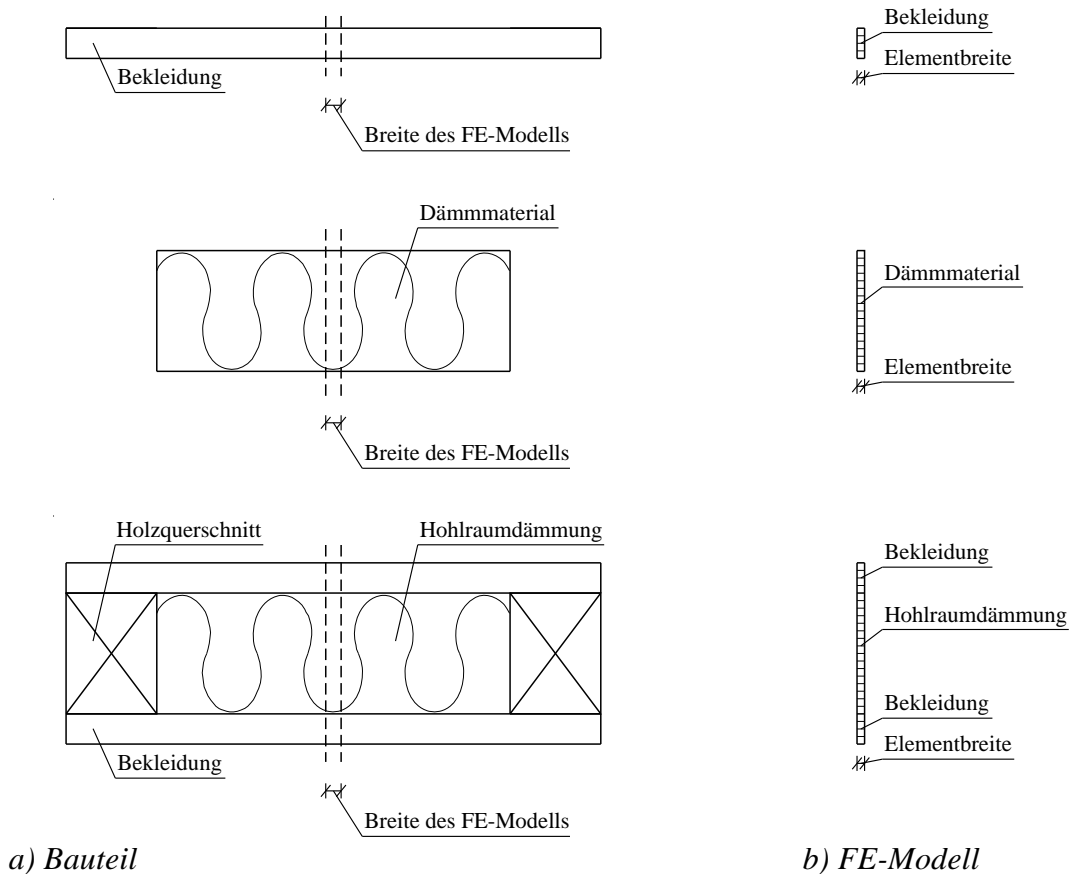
Bekleidung, Dämmmaterial und Bauteil mit Bekleidung und Hohlraumdämmung
